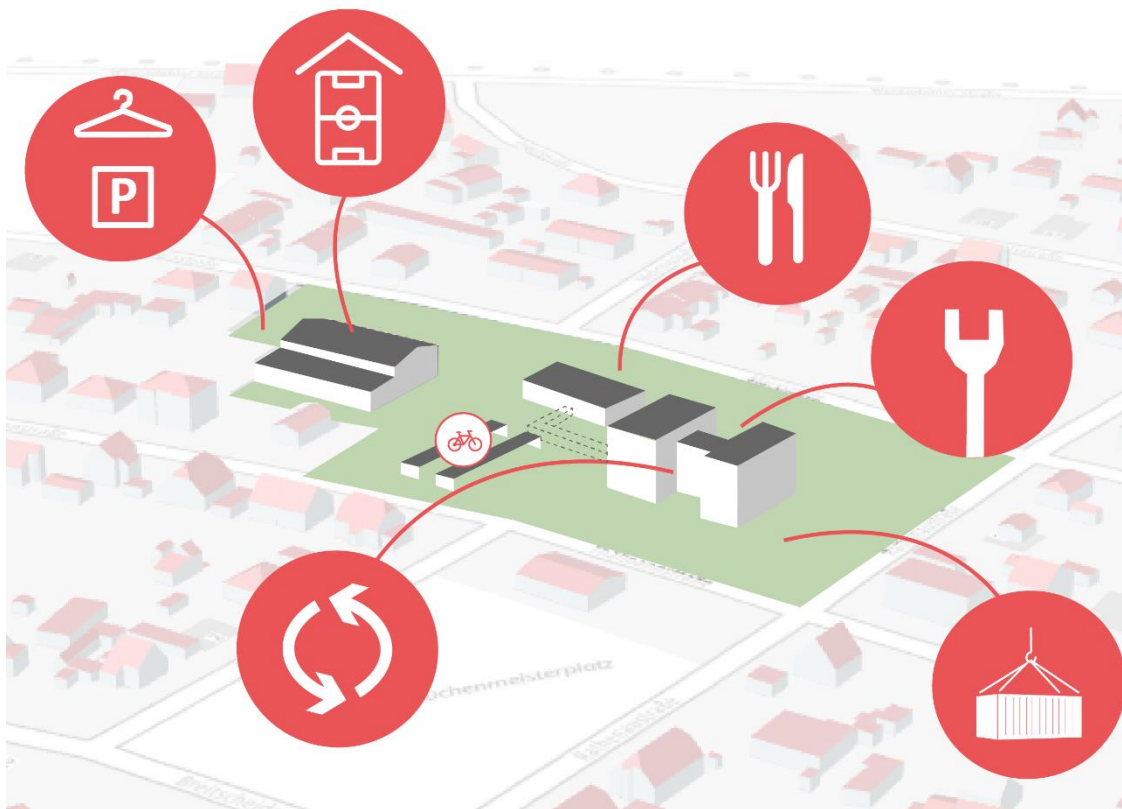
Lageplan inkl. möglichem Mensa-/Aula-Neubau
